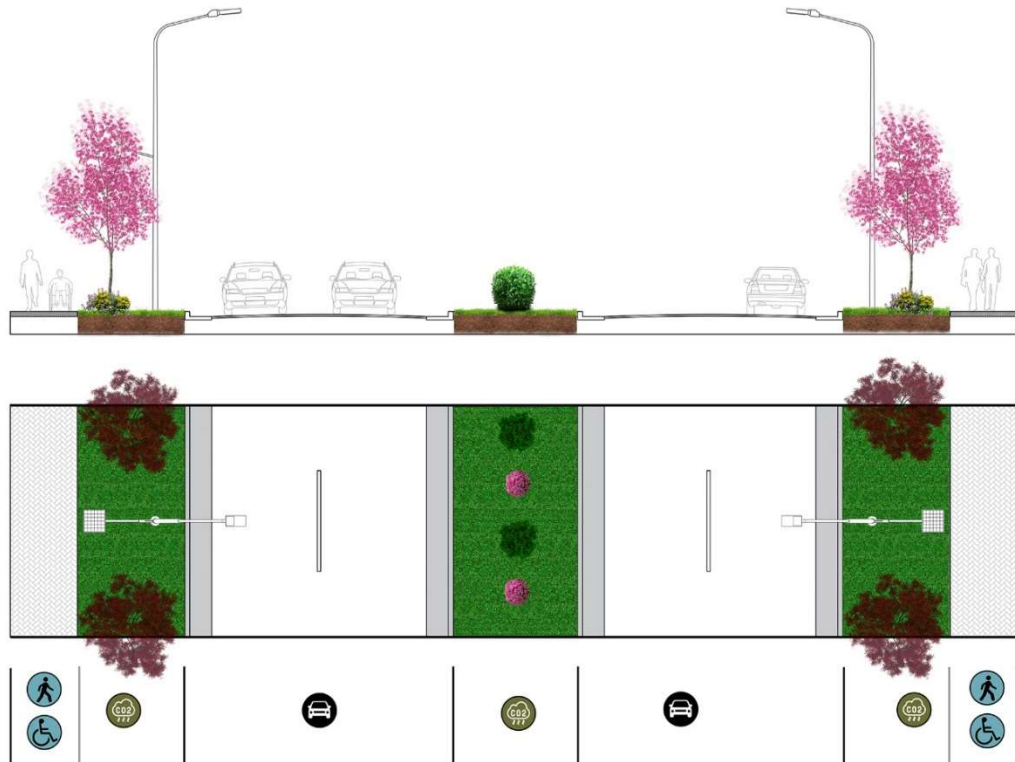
PERFIL TIPO ADOPTADO.
